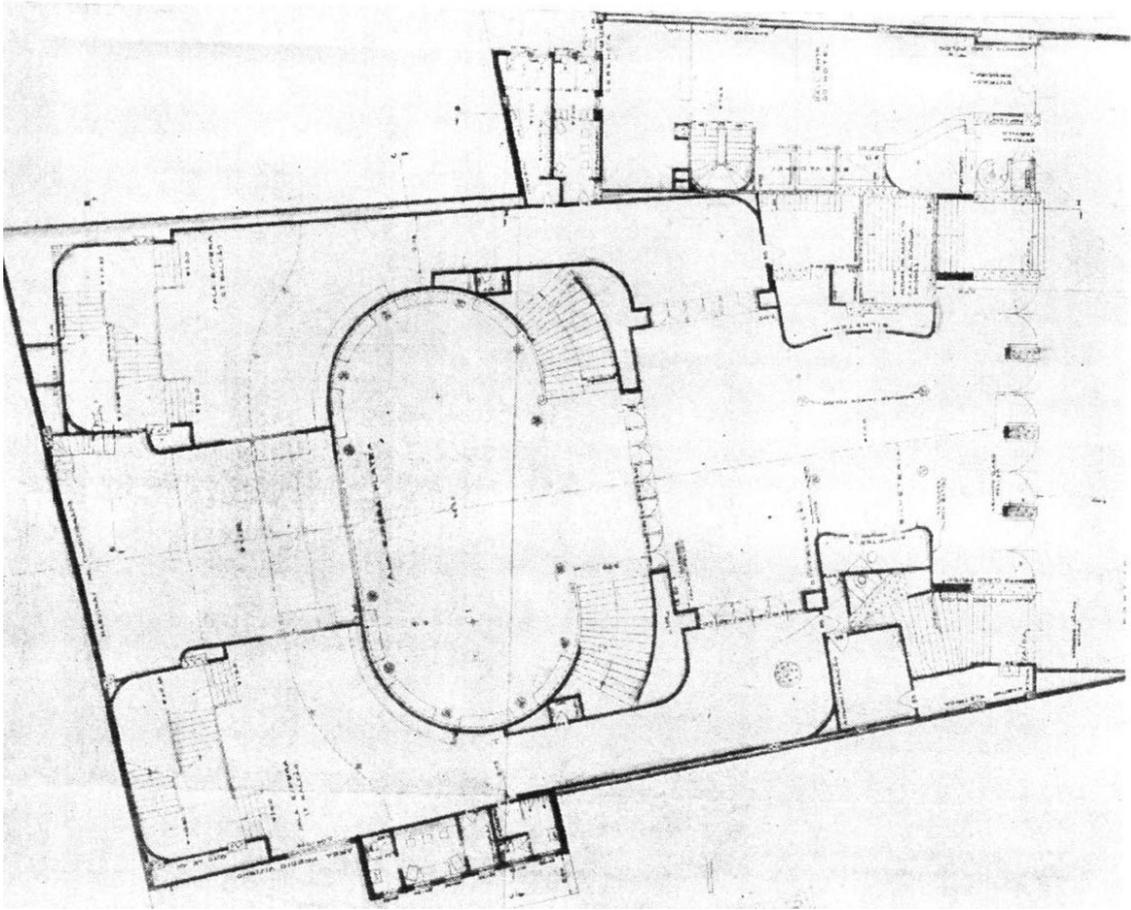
Planta do Pavimento térreo, com entrada, bilheterias e salas de espera.
